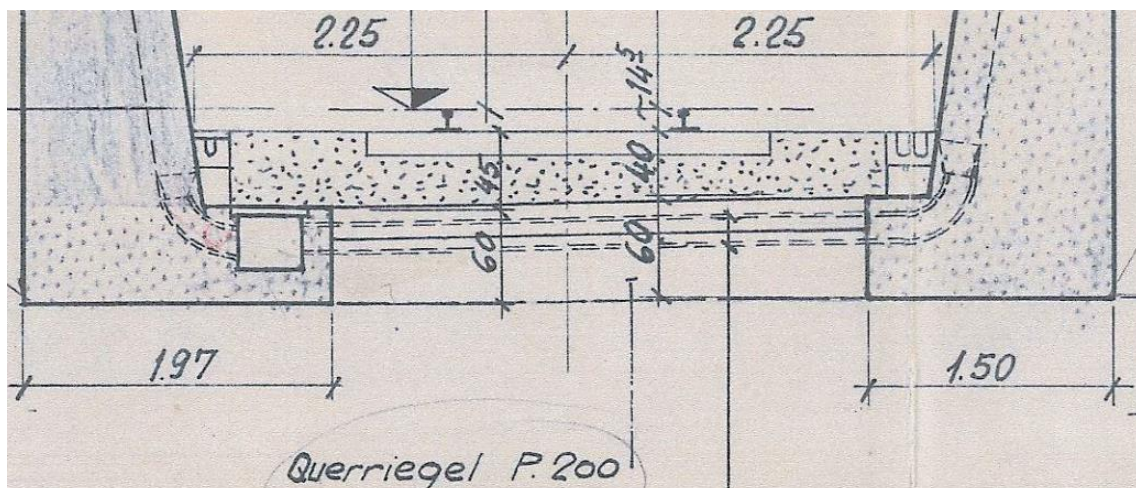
Querschnitt bestehender Oberbau in der Geraden mit Holzschwellen
